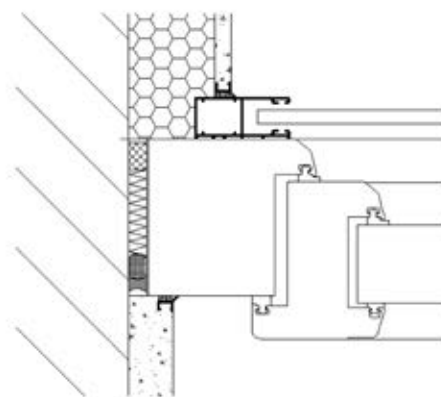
Anschlussdetail mit Führungsschiene A3 - R
